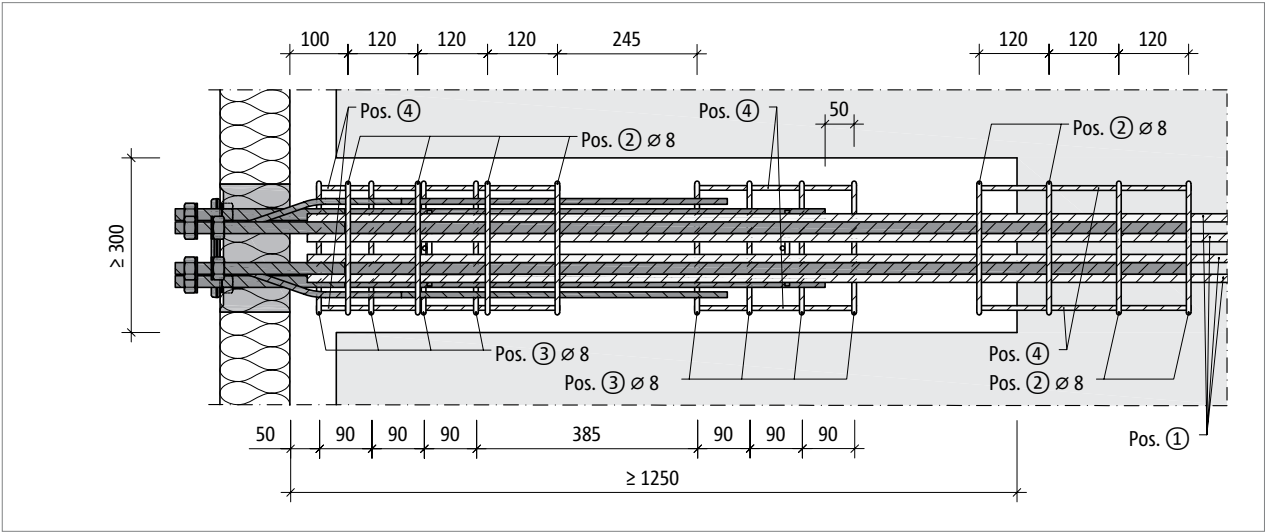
Schöck Isokorb® XT Typ SK-MM2: Bauseitige Bewehrung bei Halbfertigteilbauweise, Grundriss
